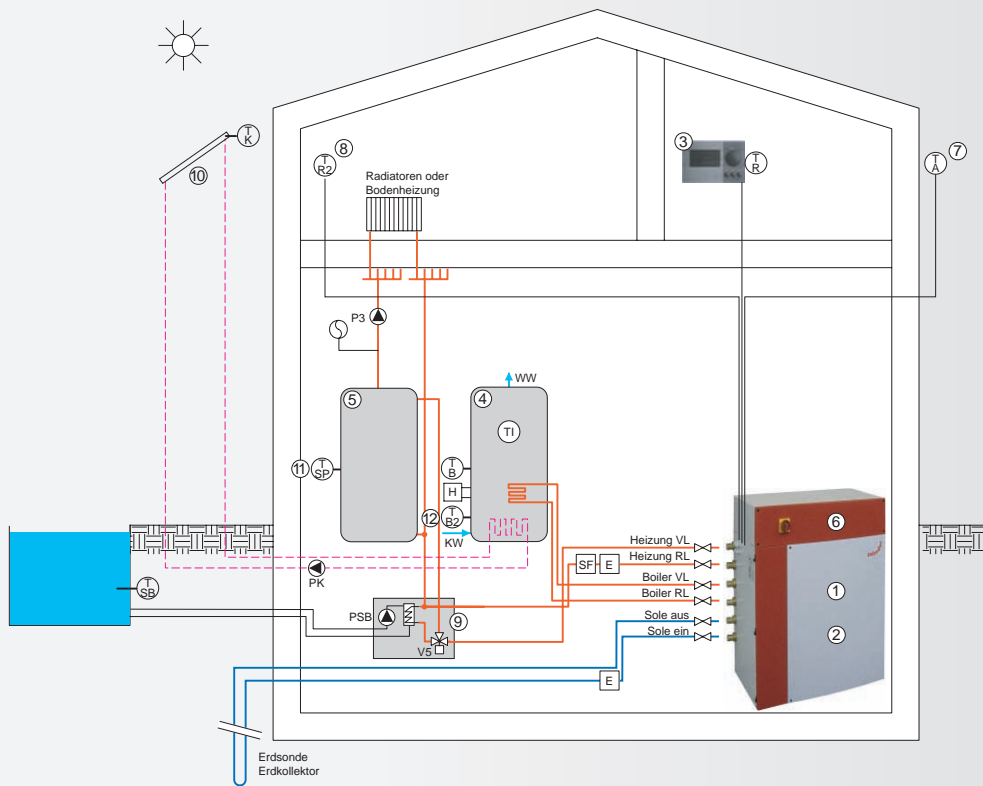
Einbauvariante 1a mit Option Schwimmbadheizung
